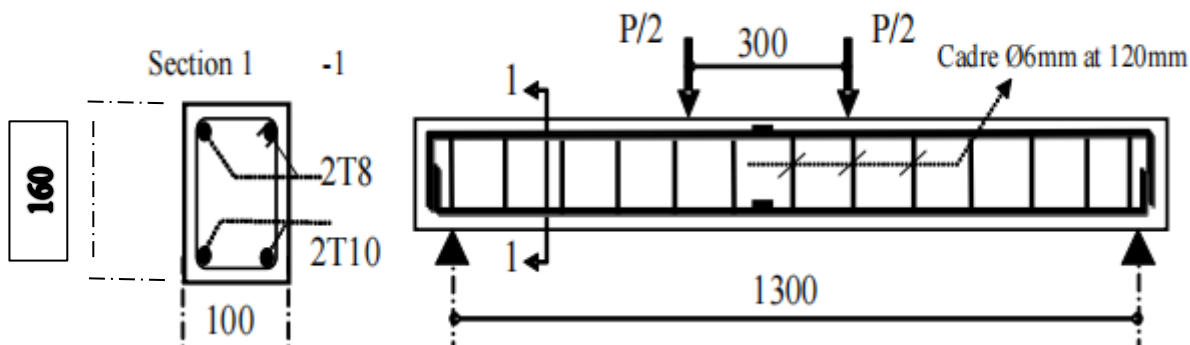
Ferrailage et dimension de la poutre expérimentée [30]
